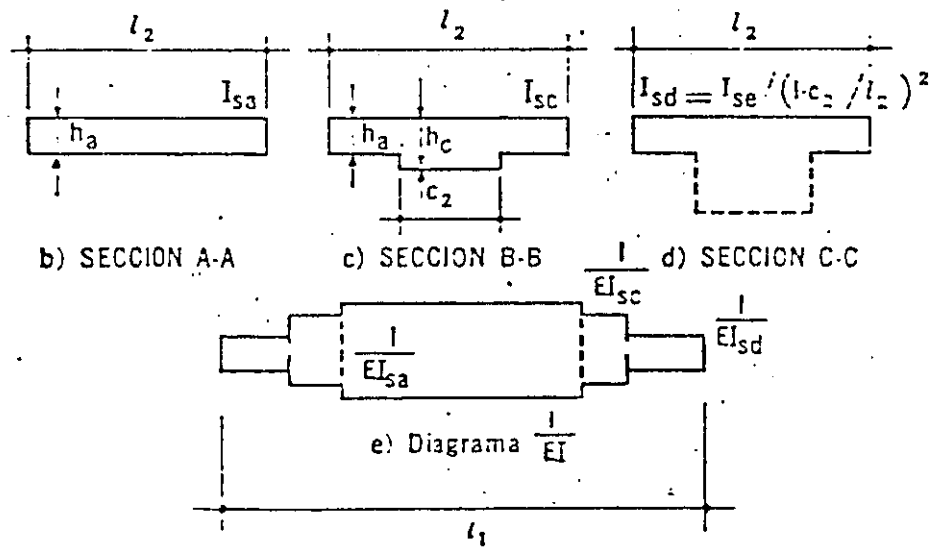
Cálculo de rigideces de vigas equivalentes en sistemas de piso sin vigas
